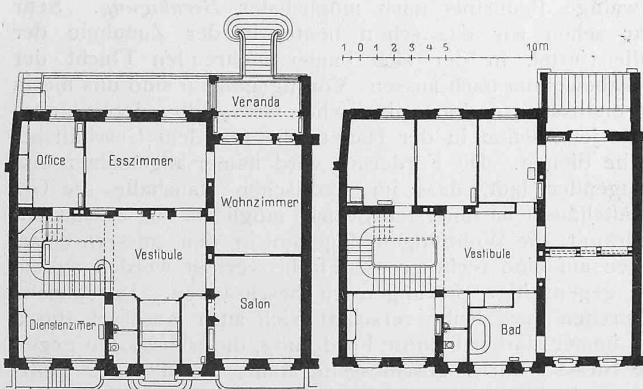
und 25. Grundrisse des Familienhauses an der Hartstrasse.
